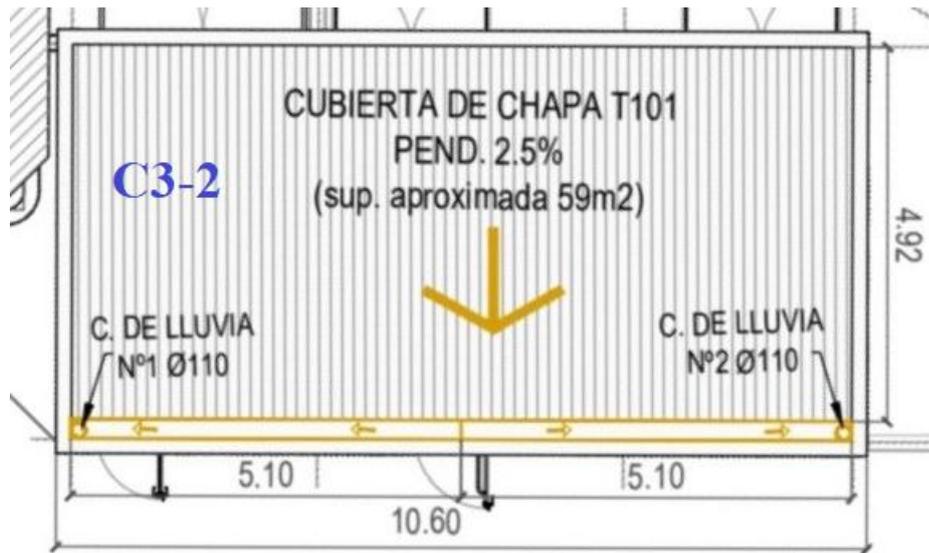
Planta de techos, Edificio C3-2 a desaguar en paso fronterizo La Quiaca - Provincia de Jujuy
